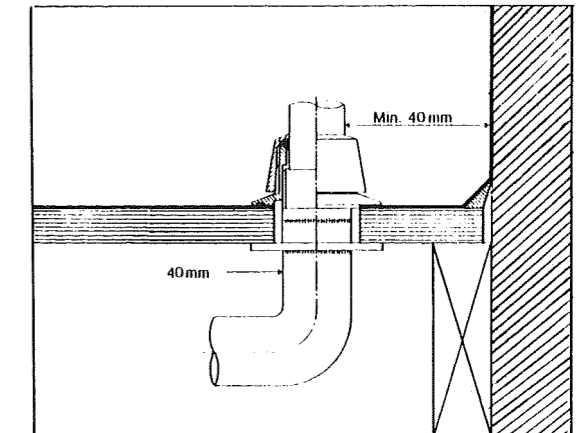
Pladsmontage af gulvafløb. Gulvafløbet, der skal være af samme type som nævnt for figur I 02 monteres i særskilt montageplade af krydsfinér. Montageplade med gulvafløb monteres til gulvplanker. Montagepladens sider understøttes. Planke med udkæring for afløb understøttes til eksisterende gulv og ovenliggende pladesamling sløjfes og limes. Forinden gulvafløbet monteres, skal påsvejses et 100 mm langt afløbsrør til gulvafløbets udløb for at muliggøre den efterfølgende afløbstilslutning.
